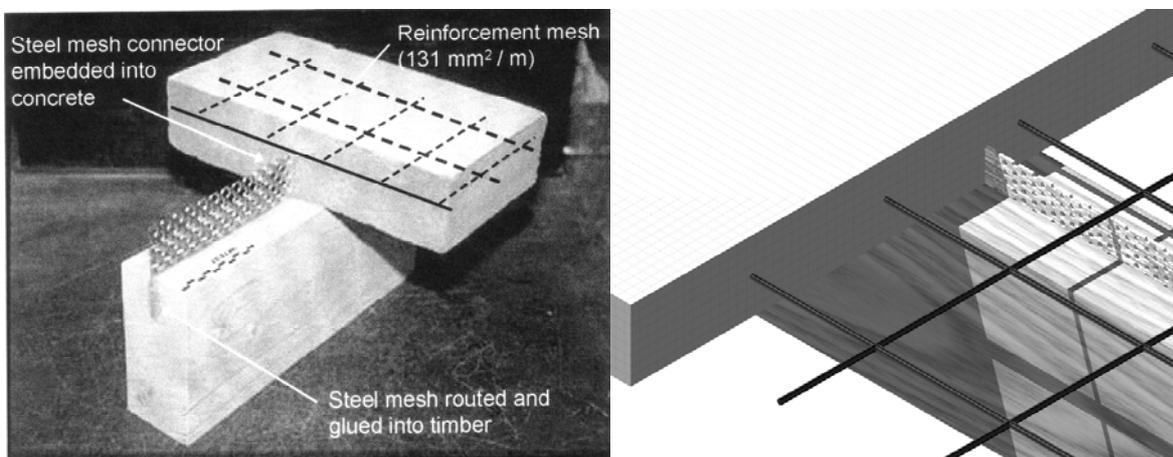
und 2: Eingelegter HBV-Schubverbinder mit angebrachter konstruktiver Mattenbewehrung
